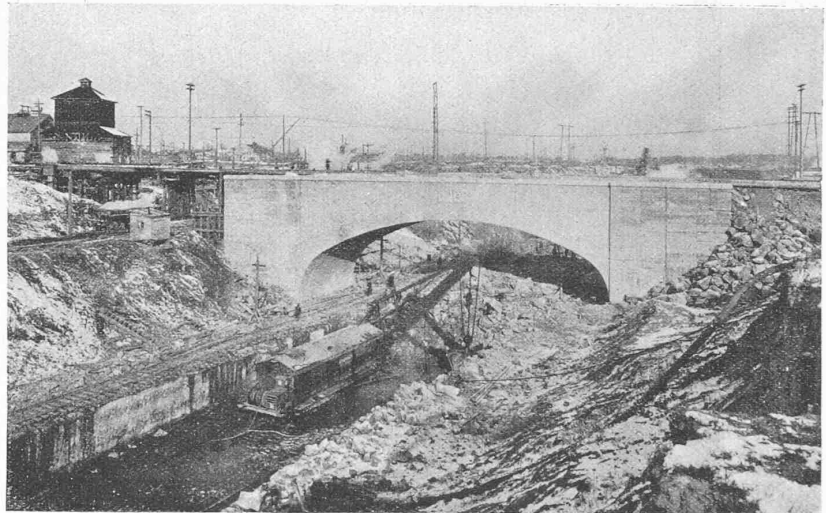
Fertige Normal-Eisenbeton-Brücke über den Kanal.
